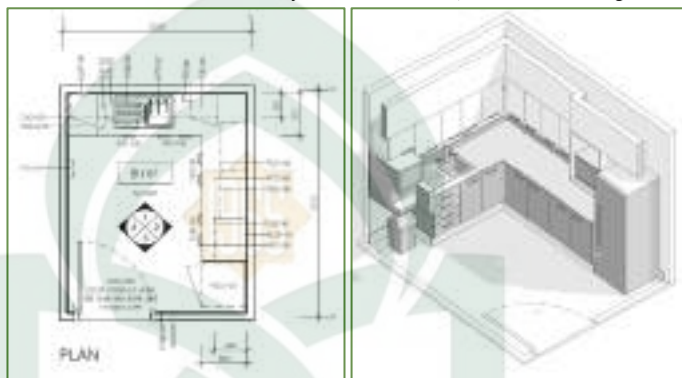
Denah layout dan 3D ruang control keamanan
